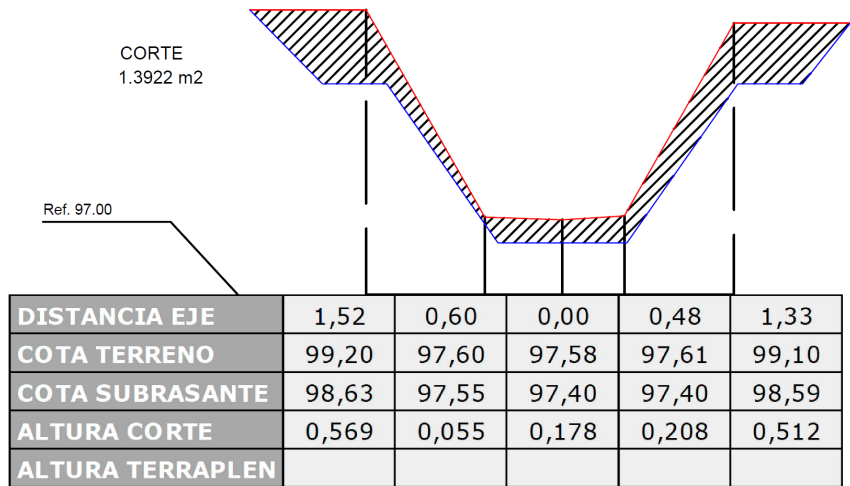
Perfil Transversal N°10 (Fuente Propia)
